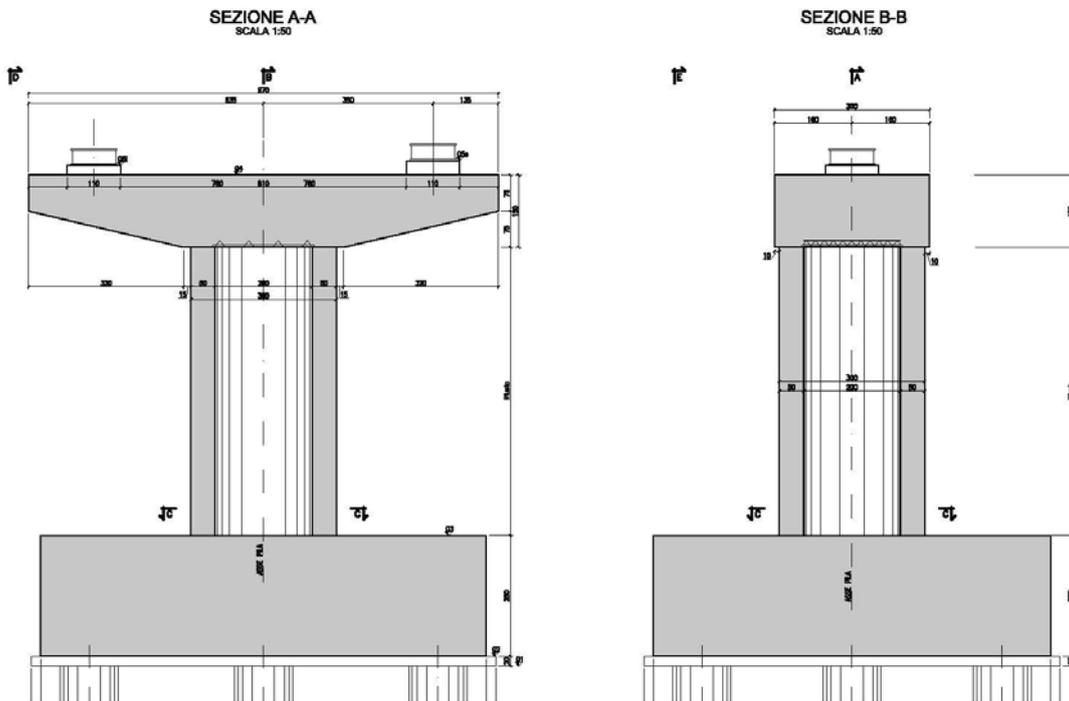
Prospetti (frontale e laterale) della pila tipo.
